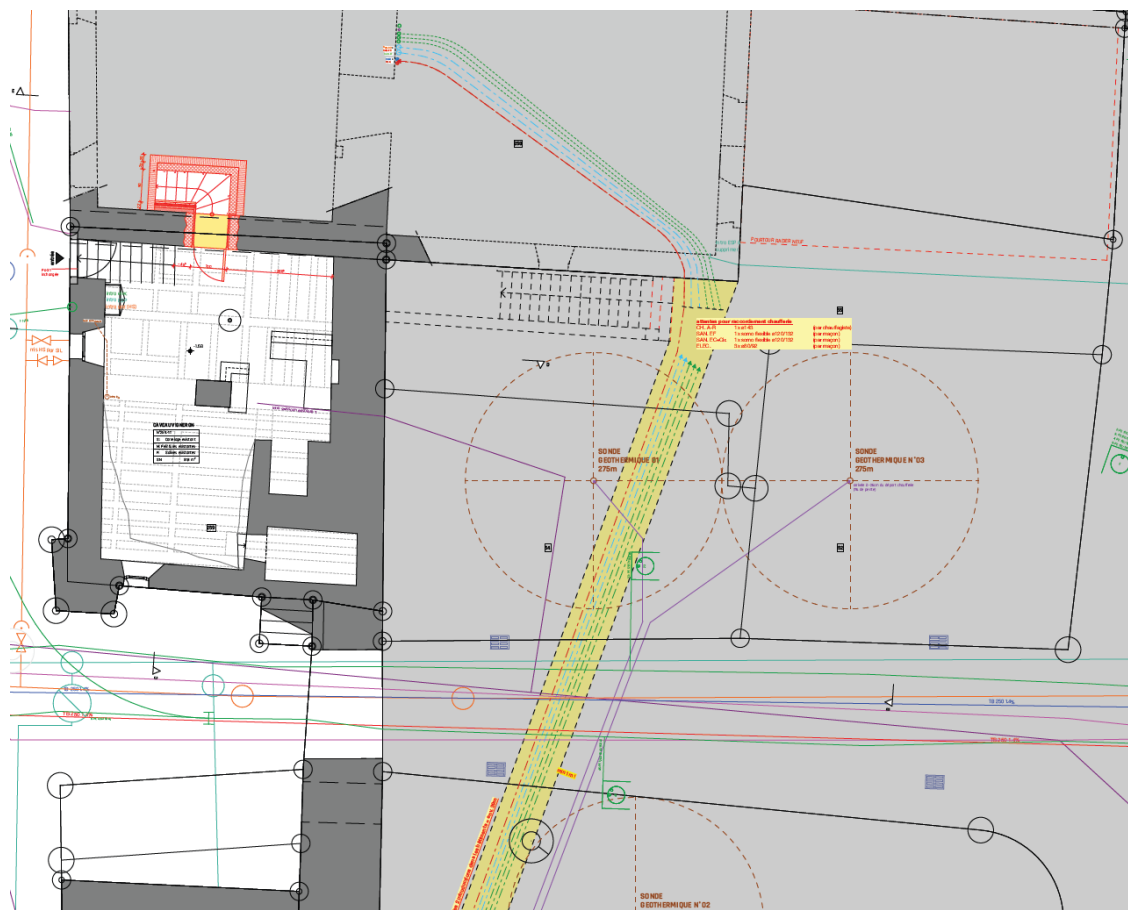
Extrait plan 51-50-1-F sous-sol 29.01.2025 (implantation des 3 sondes avec fouilles pour conduites)
